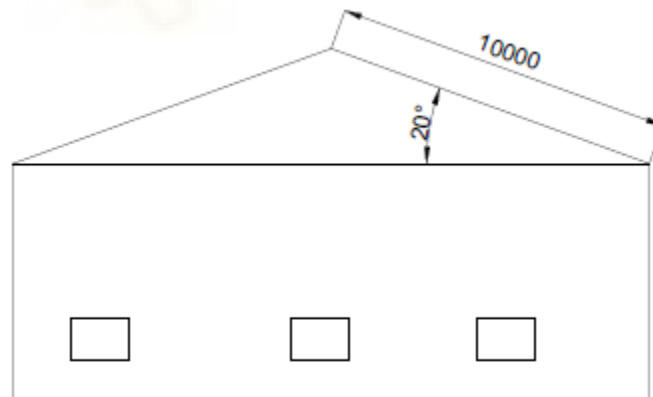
Ángulo y anchura del tejado sobre el que se instalarán las placas solares
